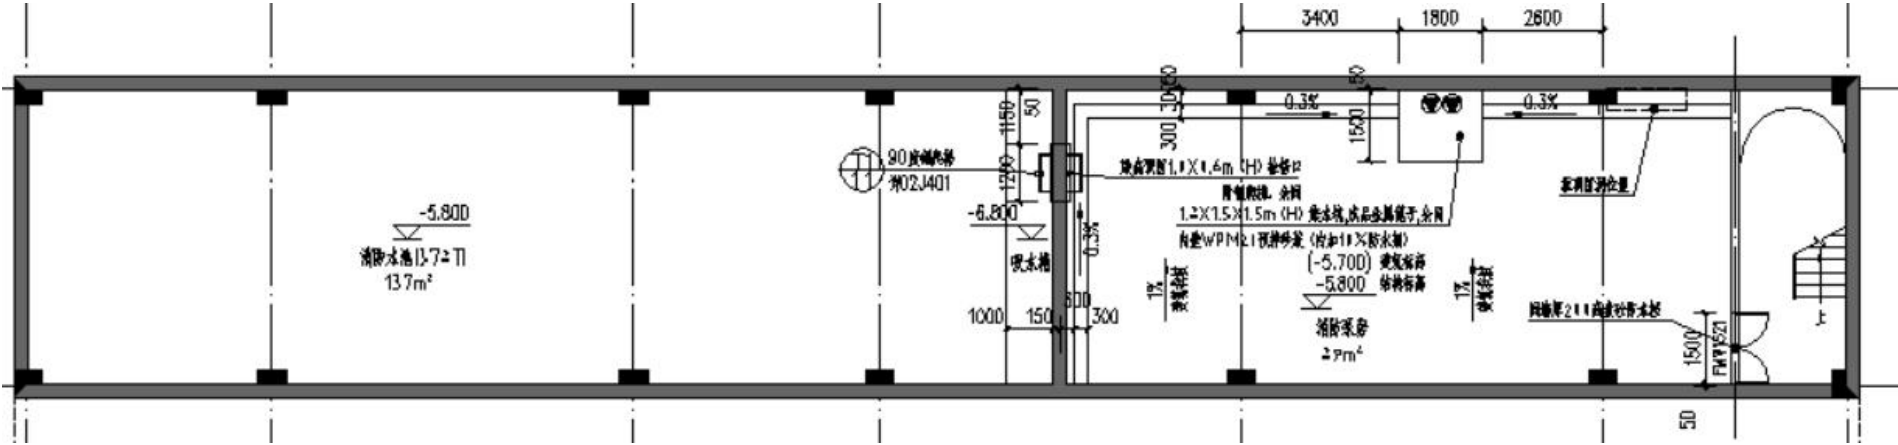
龙湖公园南门立体停车场负一层平面布置图
